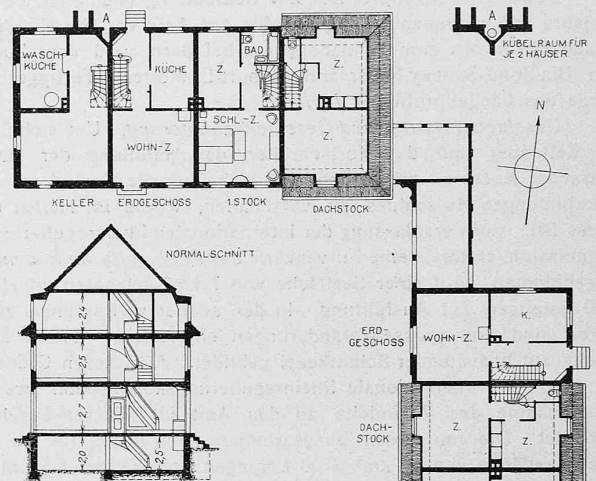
Grundrisse und Schnitt. — Masstab 1:400.
